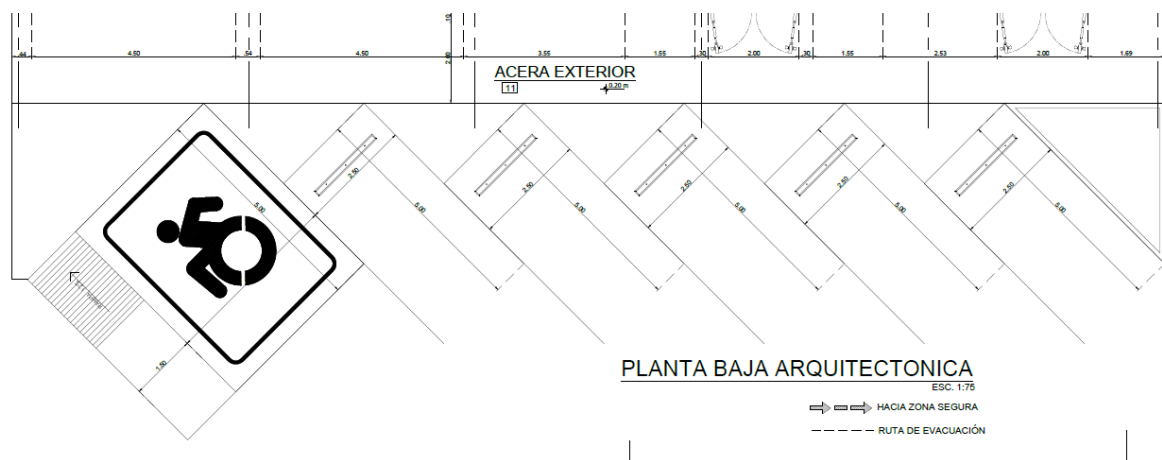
Estacionamientos del edificio. Fuente: Planos del proyecto.
